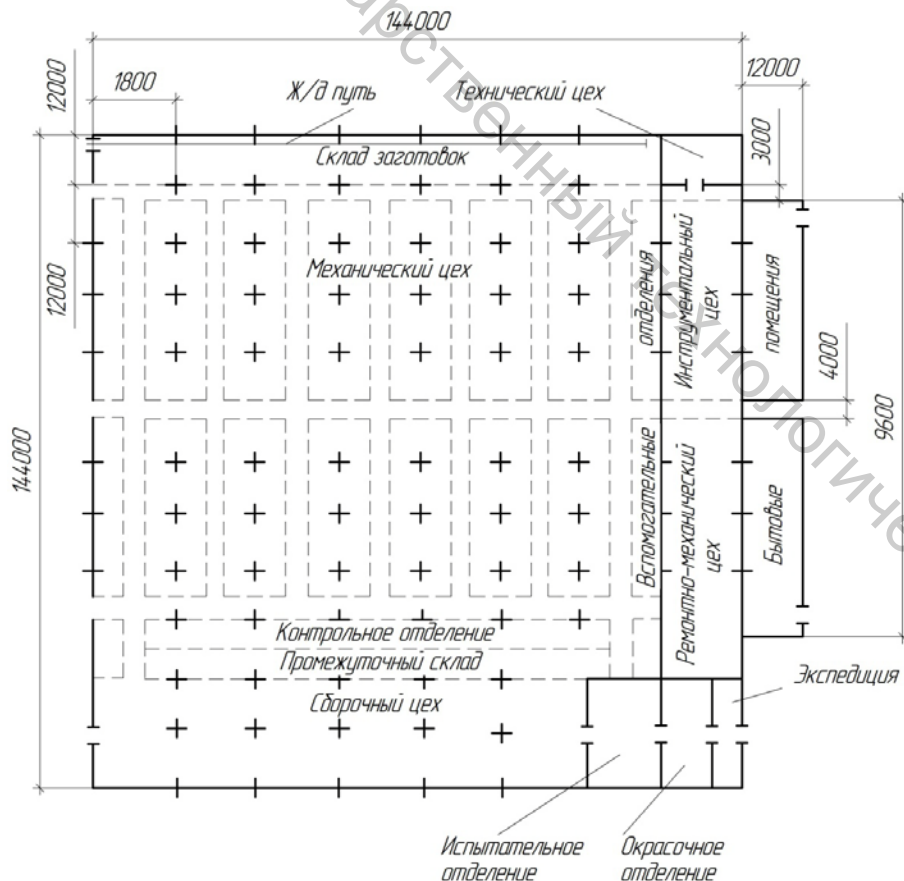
Схема компоновки нескольких цехов и склада металла и заготовок в одном корпусе
